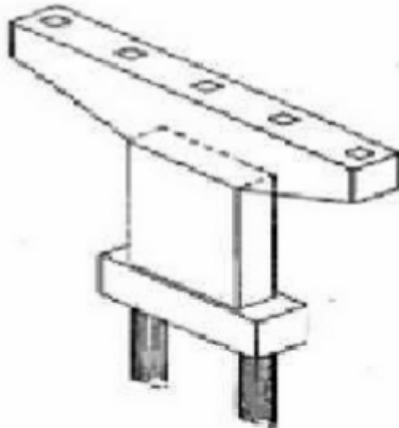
8 Abutment Tipe T Terbalik dengan Penopang
